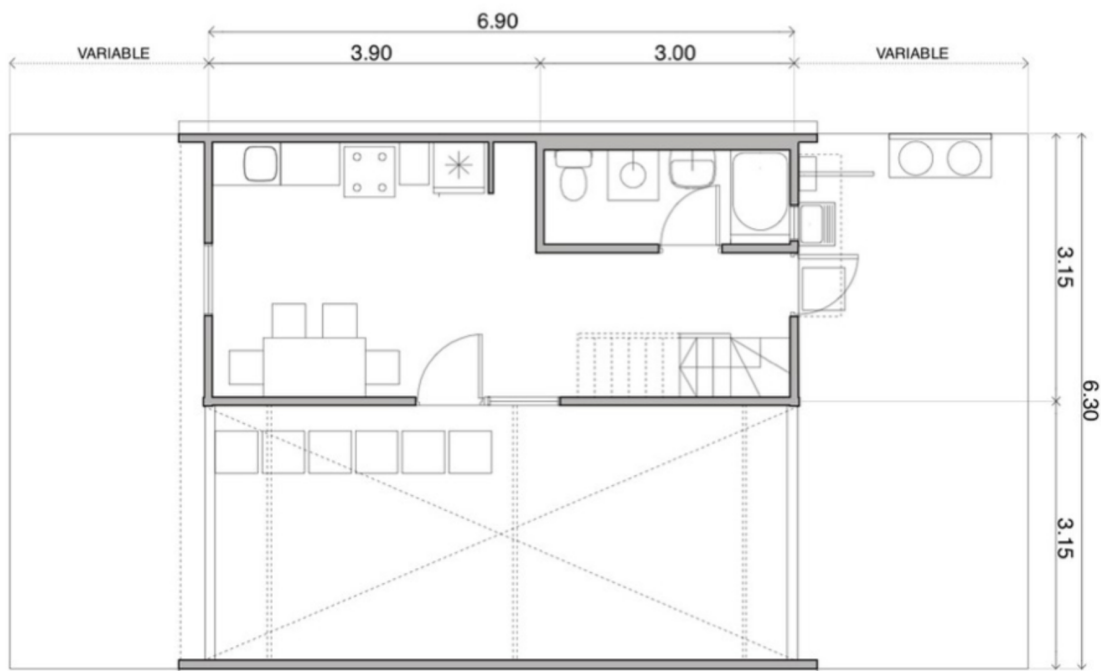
Plano del nivel 1 de la Fase 1 de la vivienda Villa Verde
